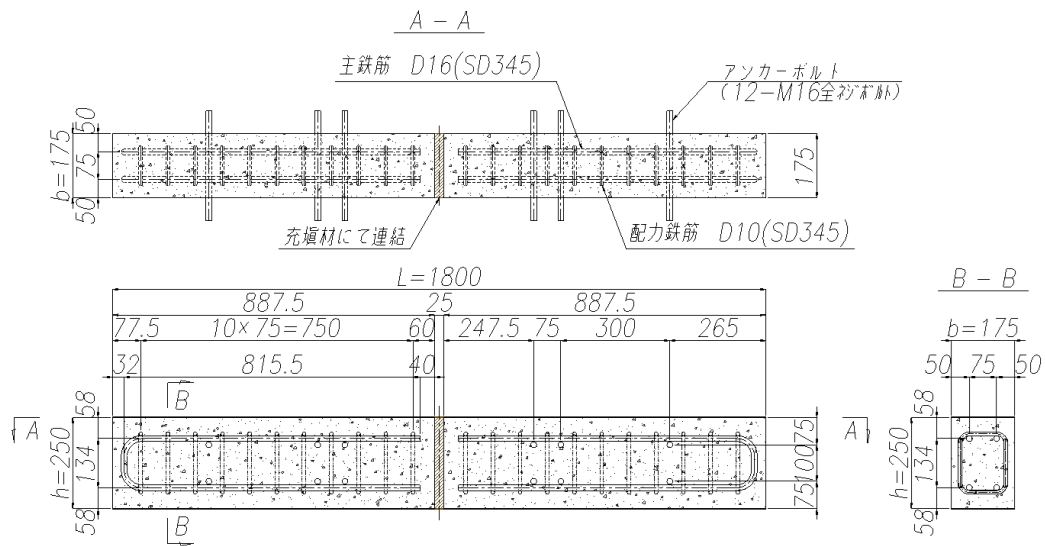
試験体寸法 (No. 1・No. 2 試験体)
